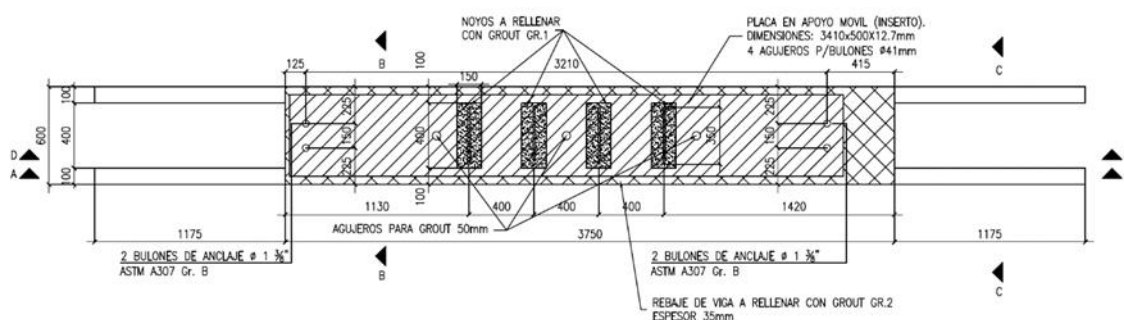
Viga premoldeada tipo “larga”. Apoyo de equipos. Encofrado.
